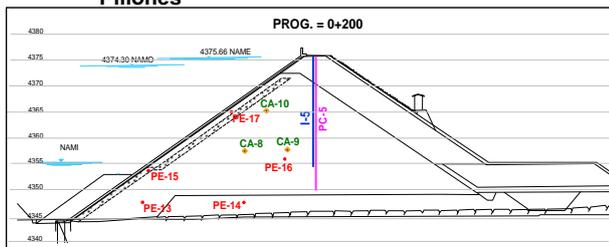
Ubicación de piezómetros, celdas de asentamiento e inclinómetro en la Sección 3-3 de la presa Pillones
